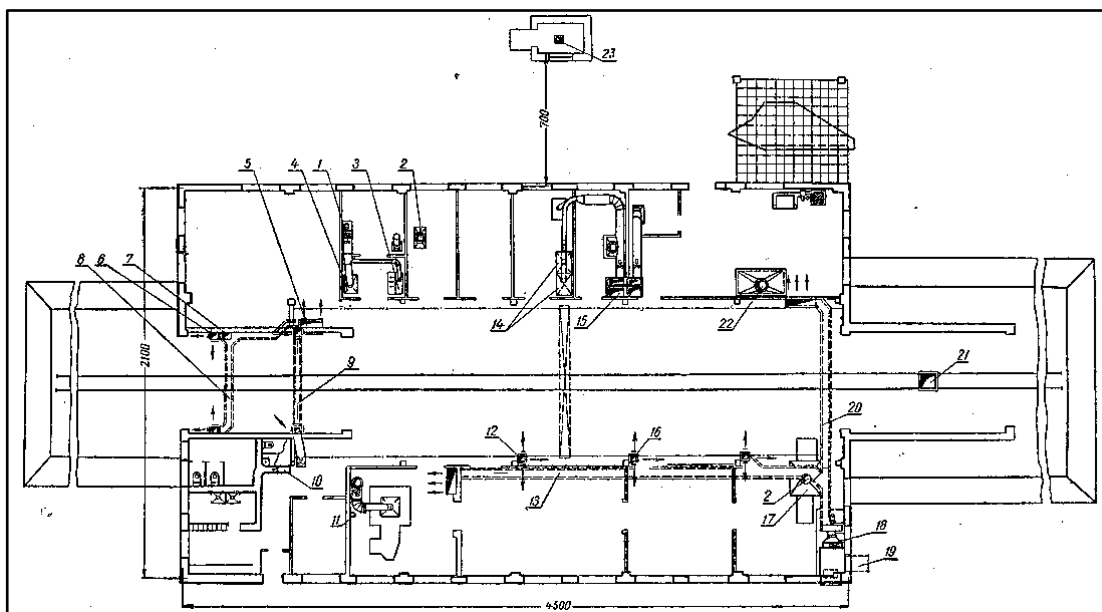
Пример плана размещения вентиляционного оборудования мастерской
